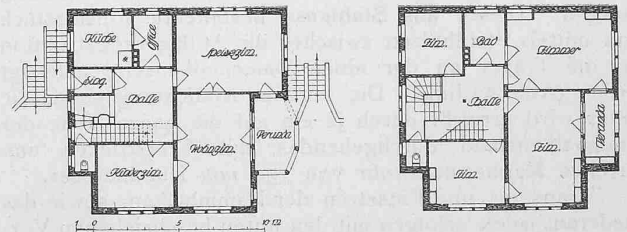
und 9. Grundrisse. — 1:400.
